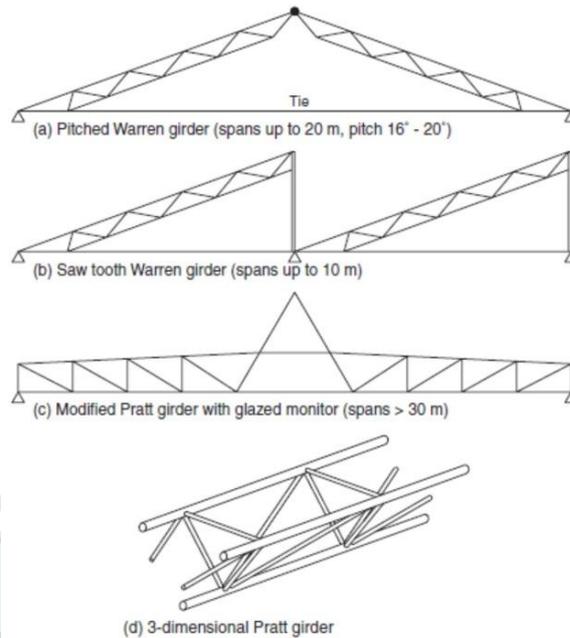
Sistem Struktur Rangka Ruang
